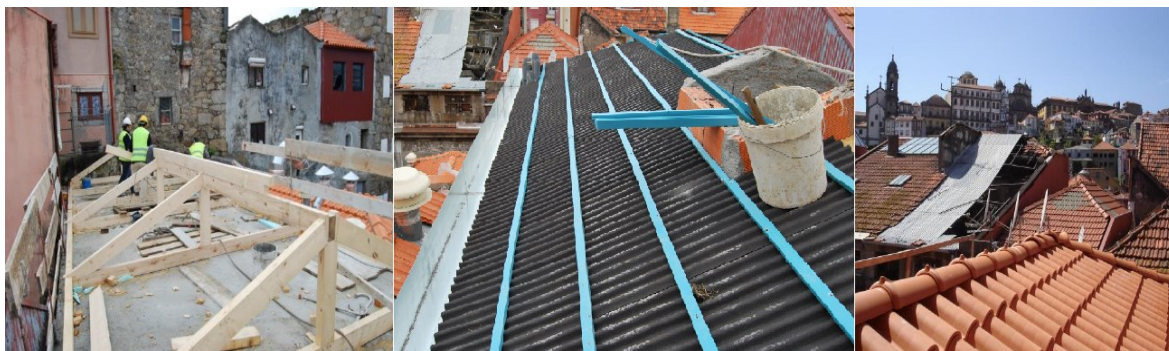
Construção da cobertura – Fonte: Porto Vivo, SRU
